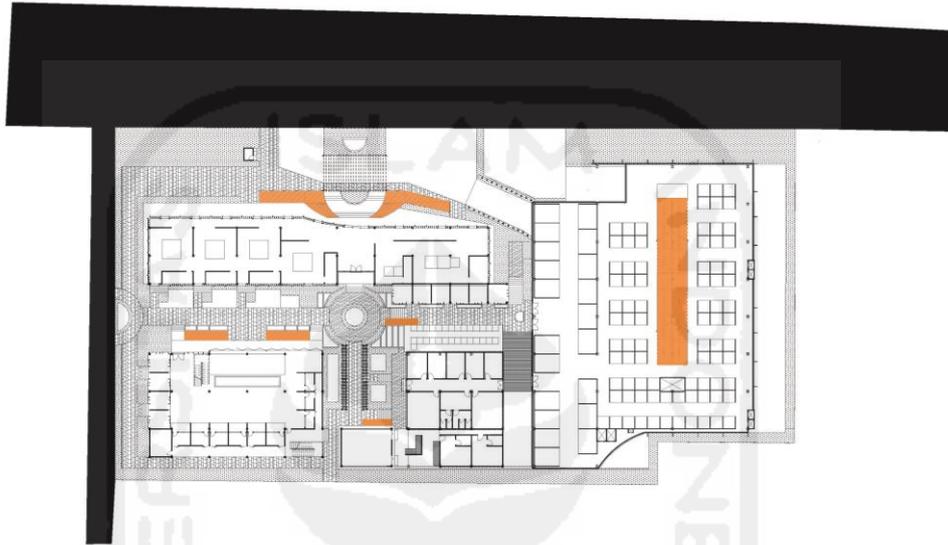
Skematik Struktur Lantai 2 Area Kuliner
